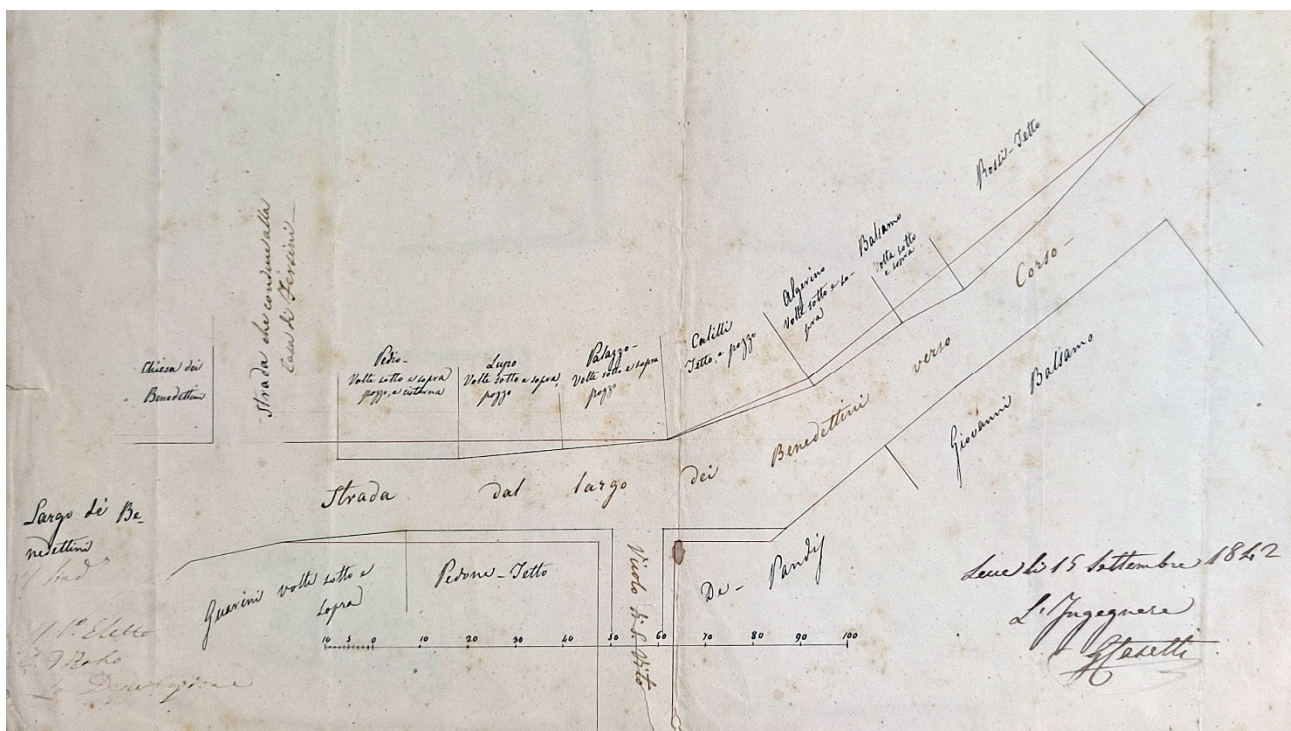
Pianta della Strada dei Benedettini, Lecce, 1842 (ASL, Int. Aff. Part.ri).
